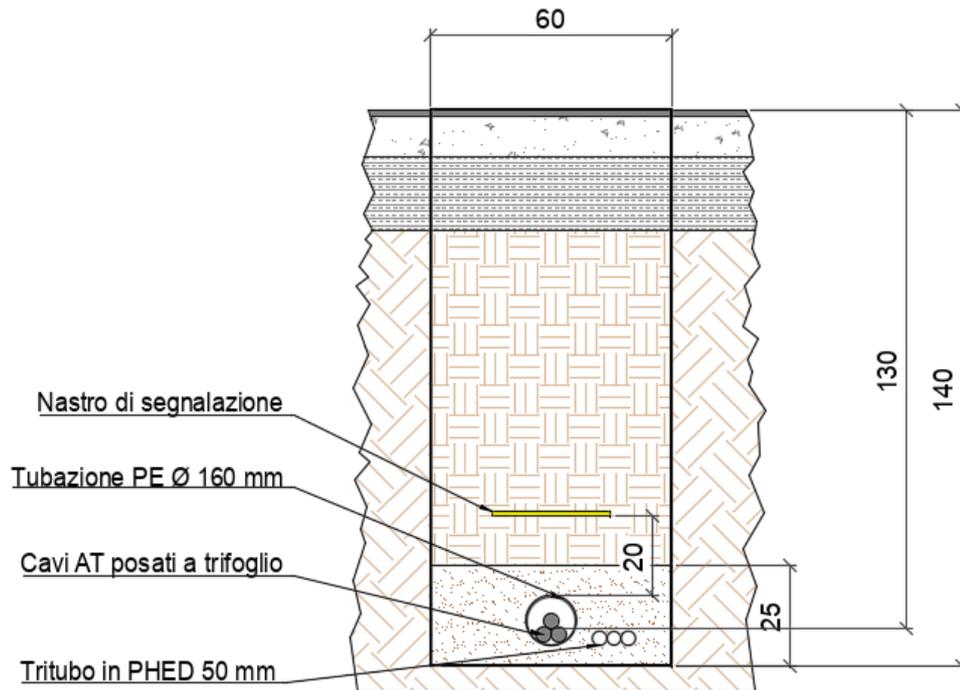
Sezione tipica di scavo per cavidotto AT in singola trincea su strada
